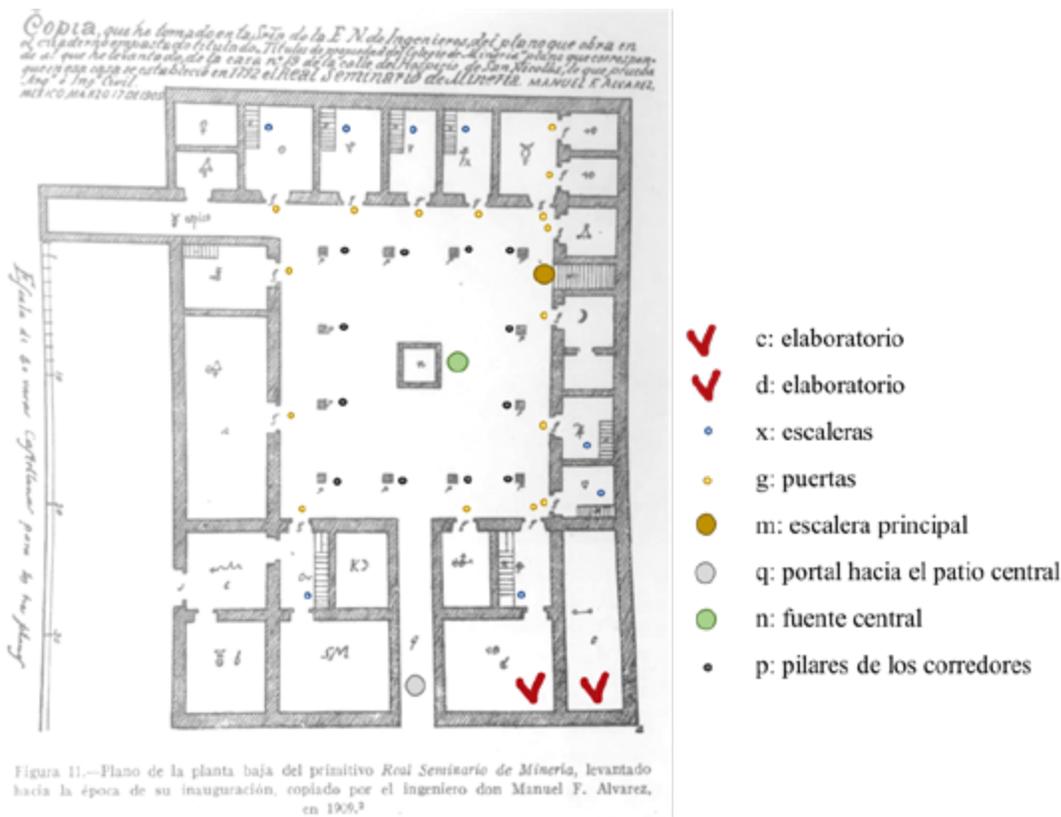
Plano de la primera planta del original del Real Seminario de Minería. Modificado de: Izquierdo, 1958, p. 42.
